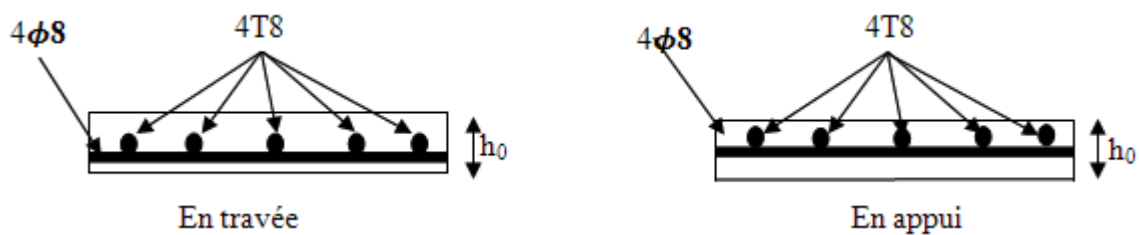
Schémas de ferrailage de la dalle du local machine.
